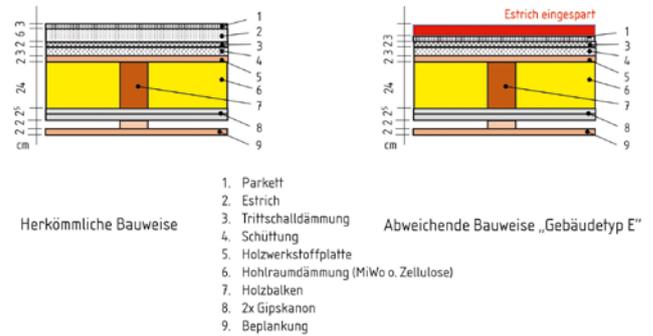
Herkömmliche Bauweise einer Holzbaugeschossdecke (links) und nach Gebäudetyp E abweichende Bauweise einer Holzbaugeschossdecke (rechts), aus [5]
